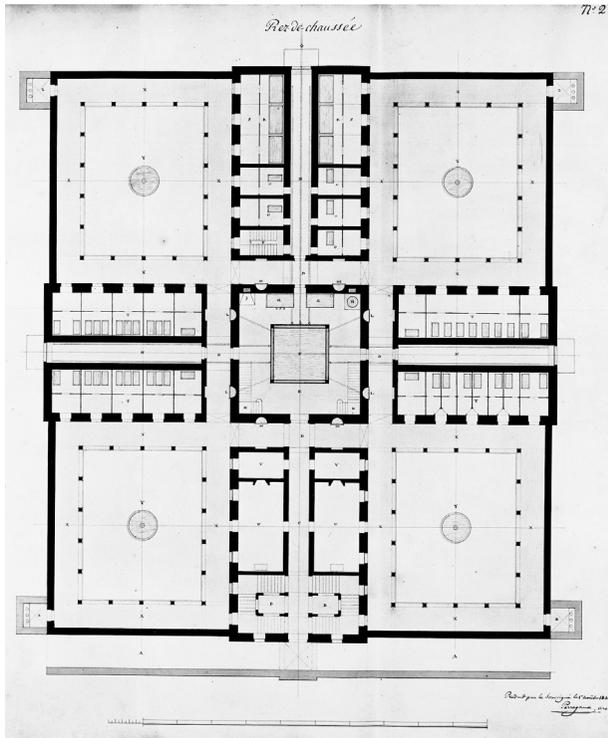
Lavey, projet d'Henri Perregaux, plan du rez-de-chaussée, 1835 (ACV).
